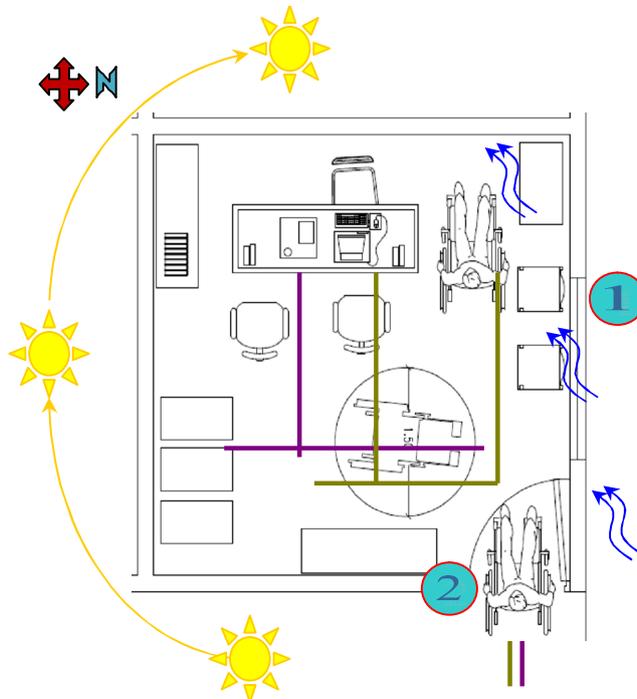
Planta Arquitectónica de oficina de Administración. /Fuente: Propia
